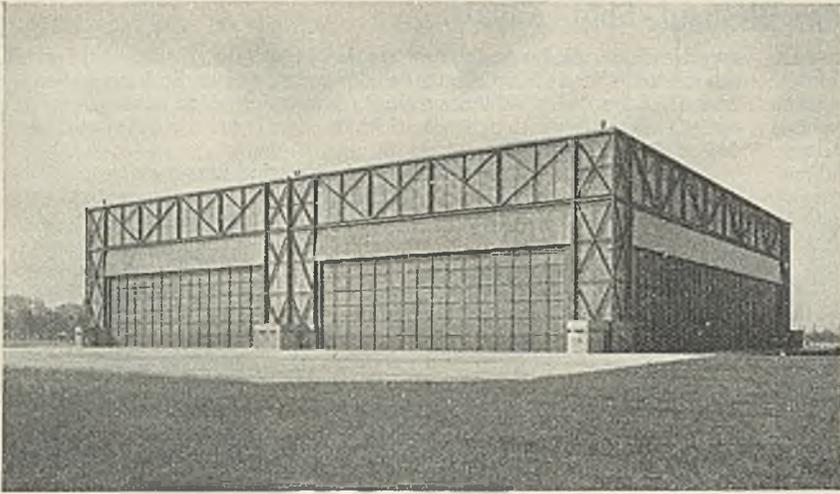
Fertige Flugzeughalle mit geschlossenen Toren.
